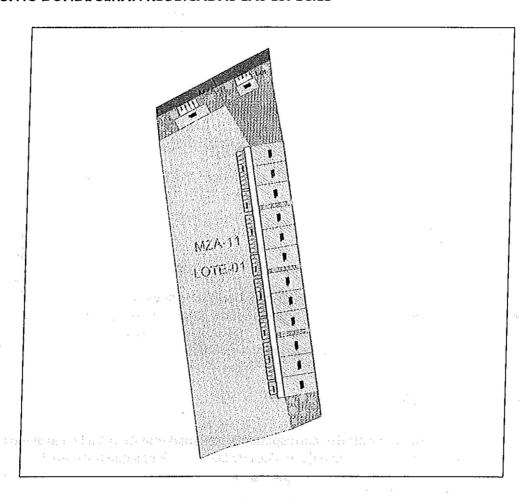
Plano de las verdes ajardinadas destinadas por Lote
